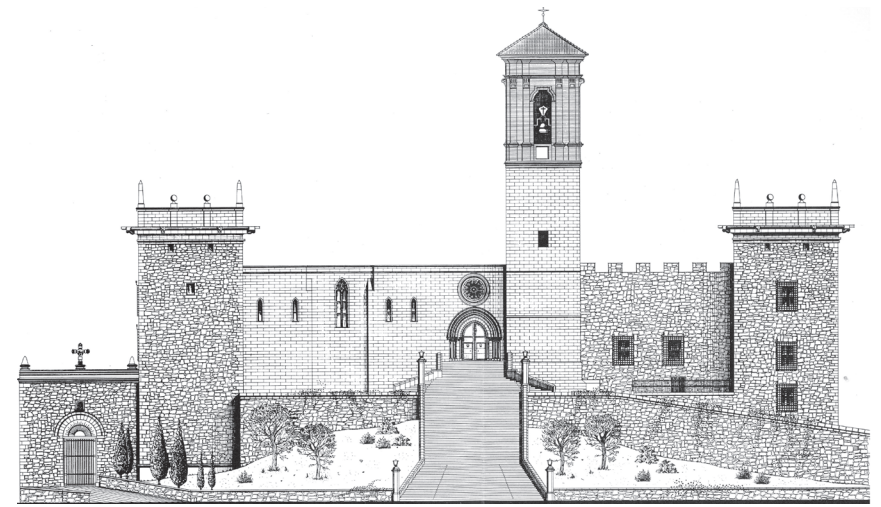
Alzado general de la fachada norte del monasterio de Santa María de El Puig (Dominguez Rodrigo)
